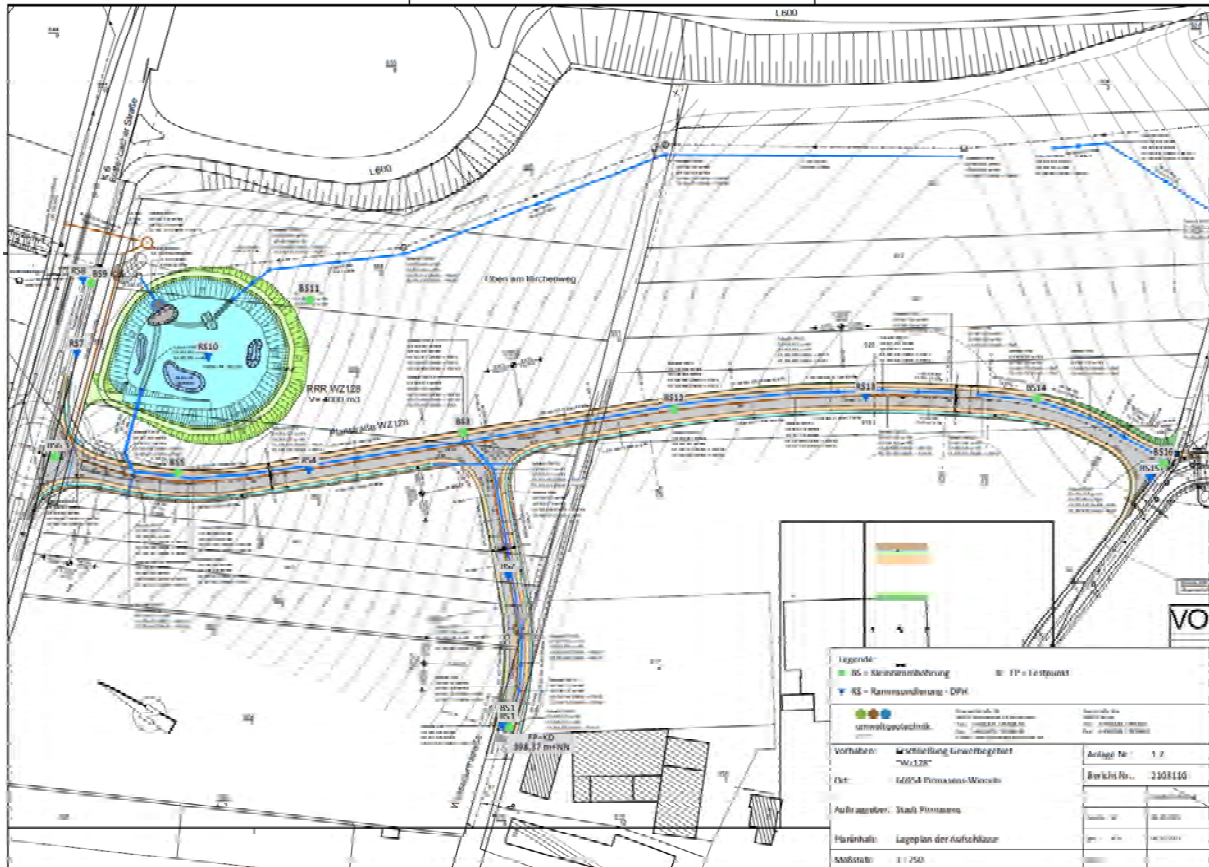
Lageplan der Aufschlüsse (Quelle: Umweltgeotechnik GmbH, Anlage 1.2 )
